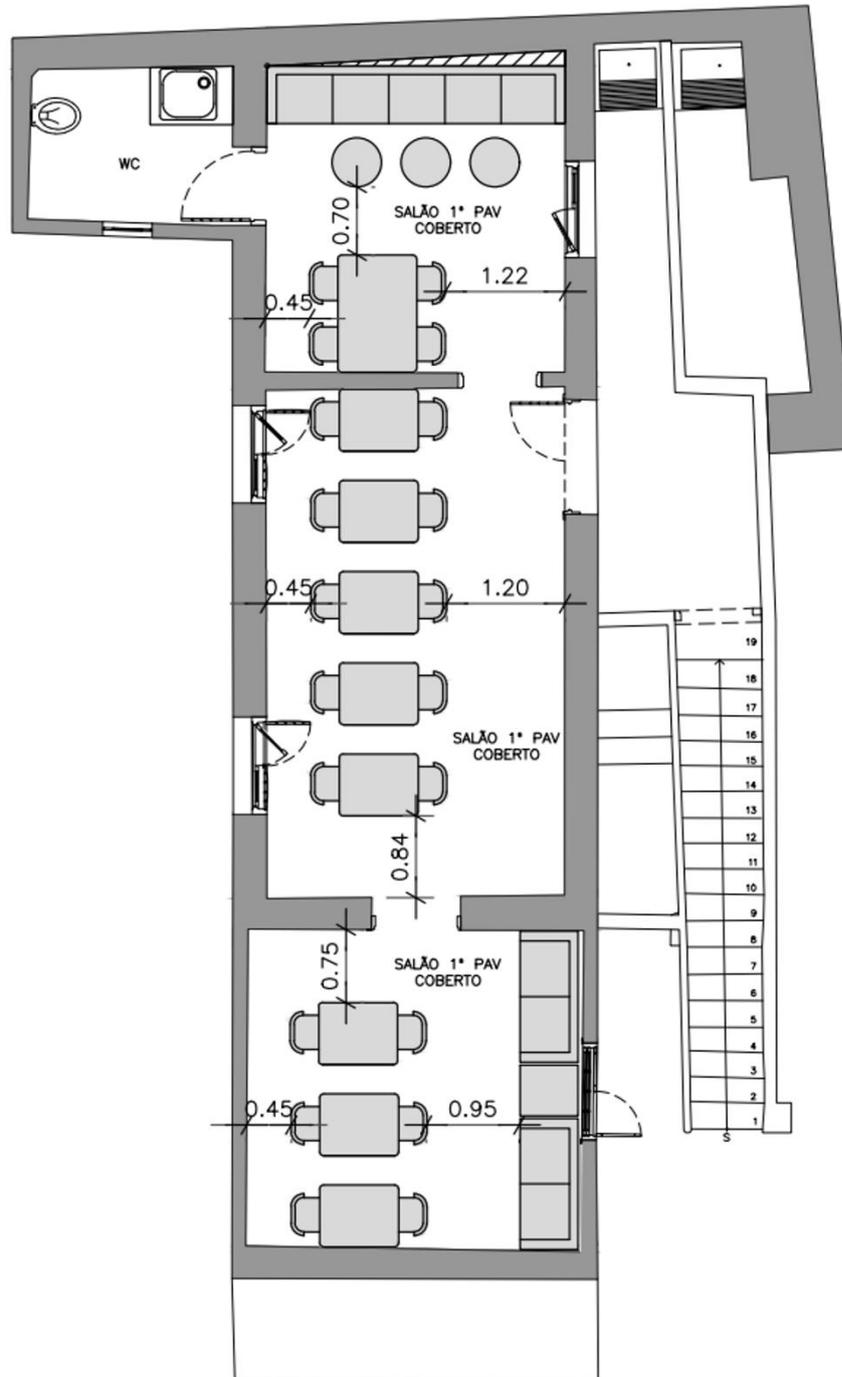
Planta Baixa Térreo: ESPAÇO GASTRONÔMICO
